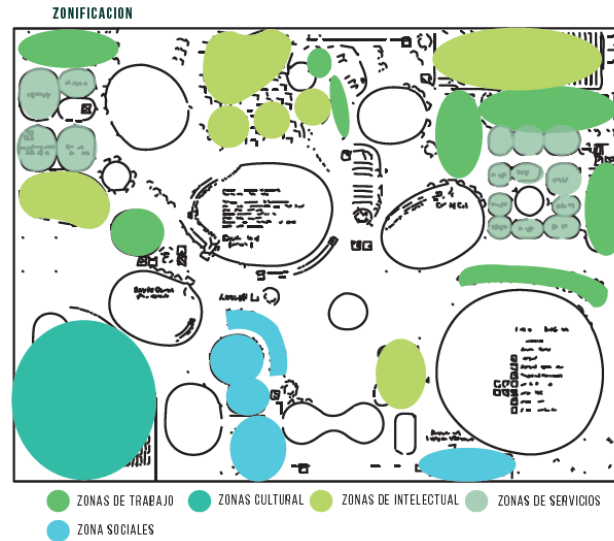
Planta arquitectónica Centro Universitario Rolex Learning
